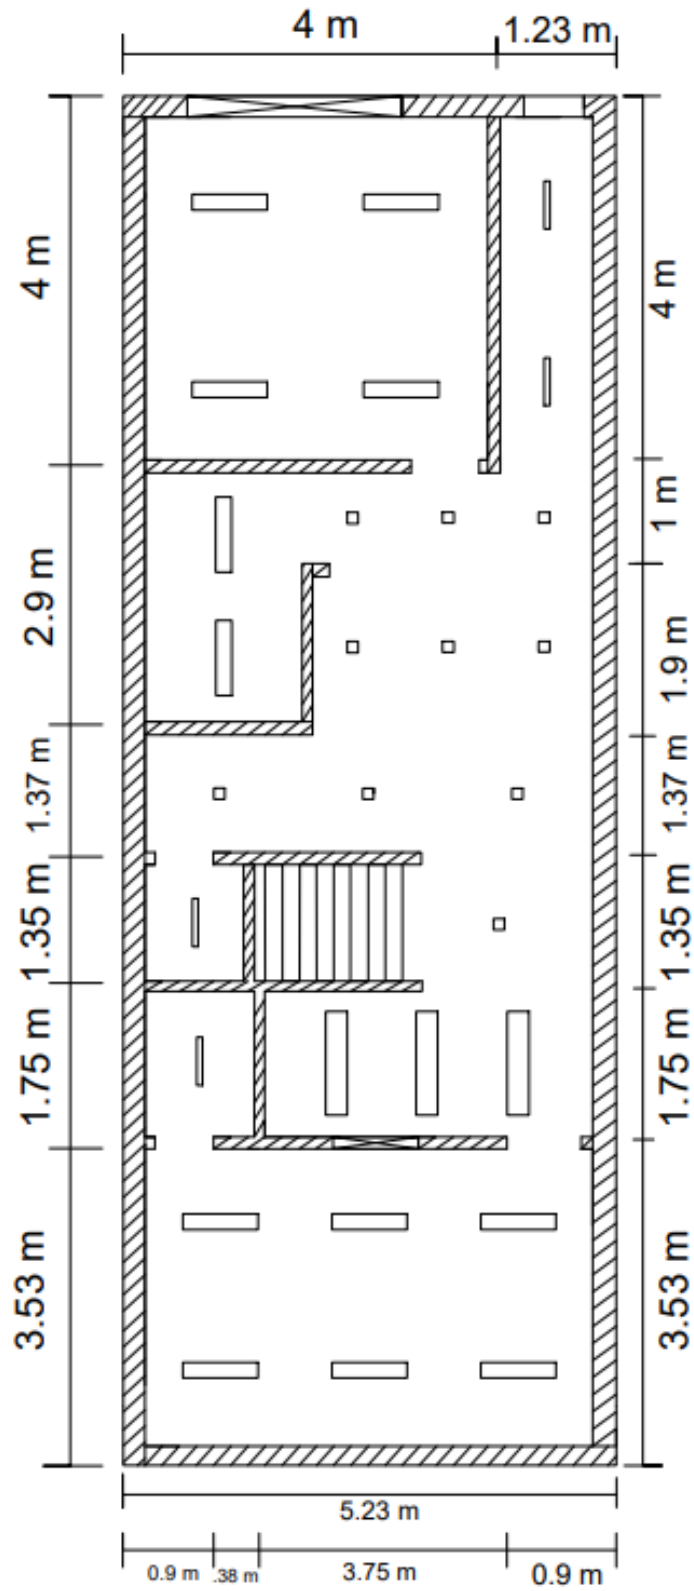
Plano de distribución de luminarias planta baja propuesta 2
